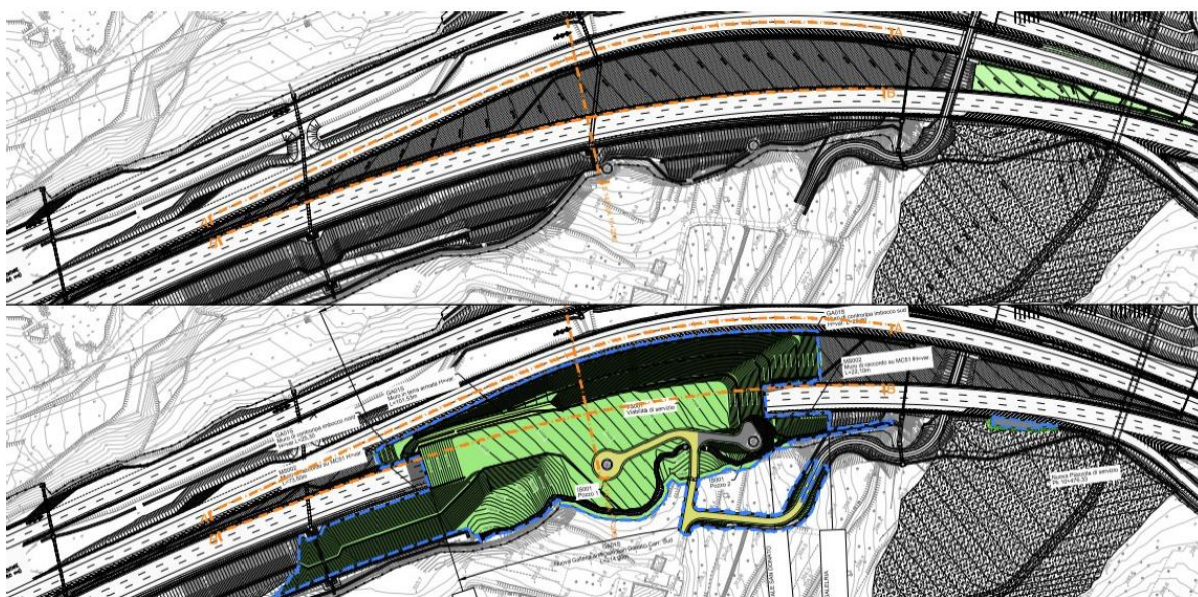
Confronto planimetrico tra il progetto approvato e la variante proposta
